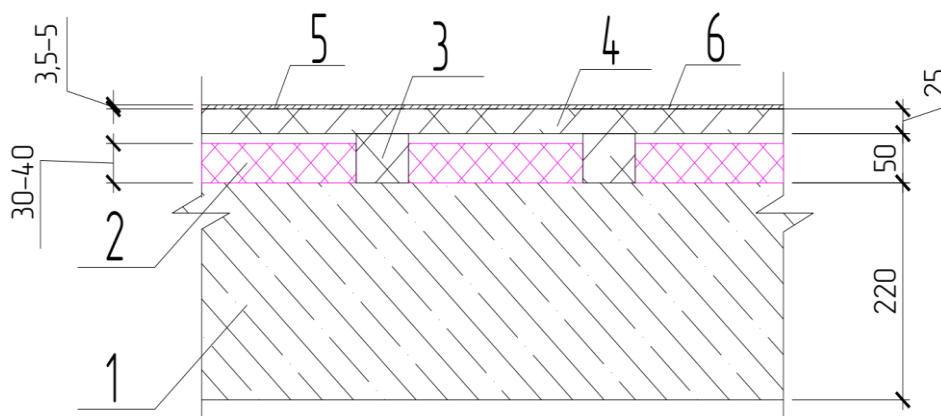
Конструкция перекрытия над неотапливаемым подвалом с применением вакуумных панелей: 1 – плита перекрытия 220 мм; 2 – вакуумная панель 30 – 40 мм; 3 – лаги; 4 – фанера/дощатые полы 25 мм; 5 – подложка вспененная 1 слой; 6 – пол (щиты паркетные) 3,5-5 мм.
